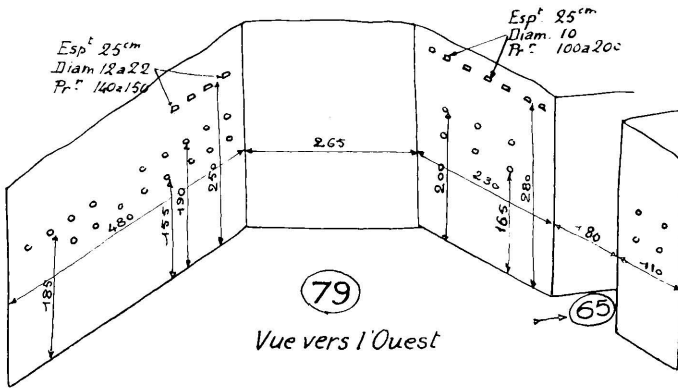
Salle 79. Élévation des murs, avec trous de chaînage.
